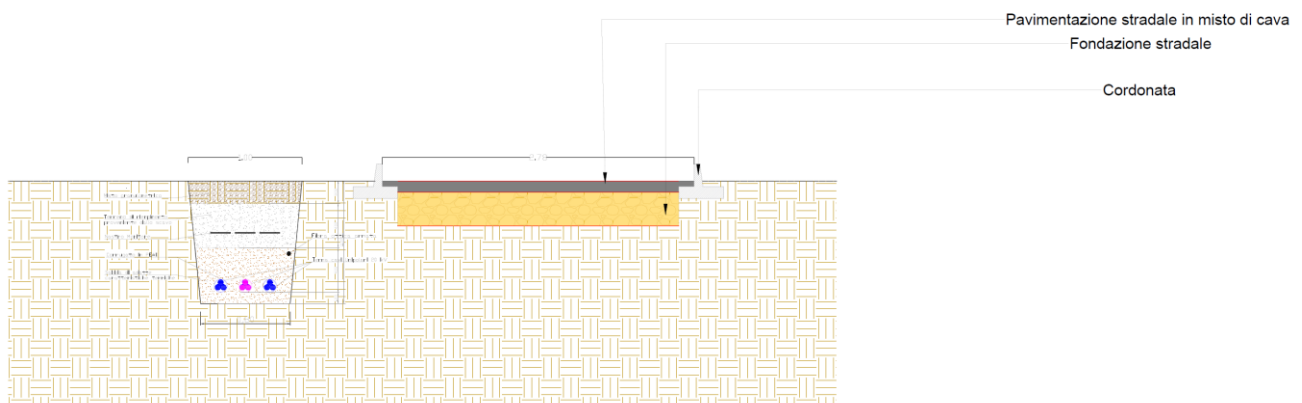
sezione del cavidotto lungo la viabilità esistente.
